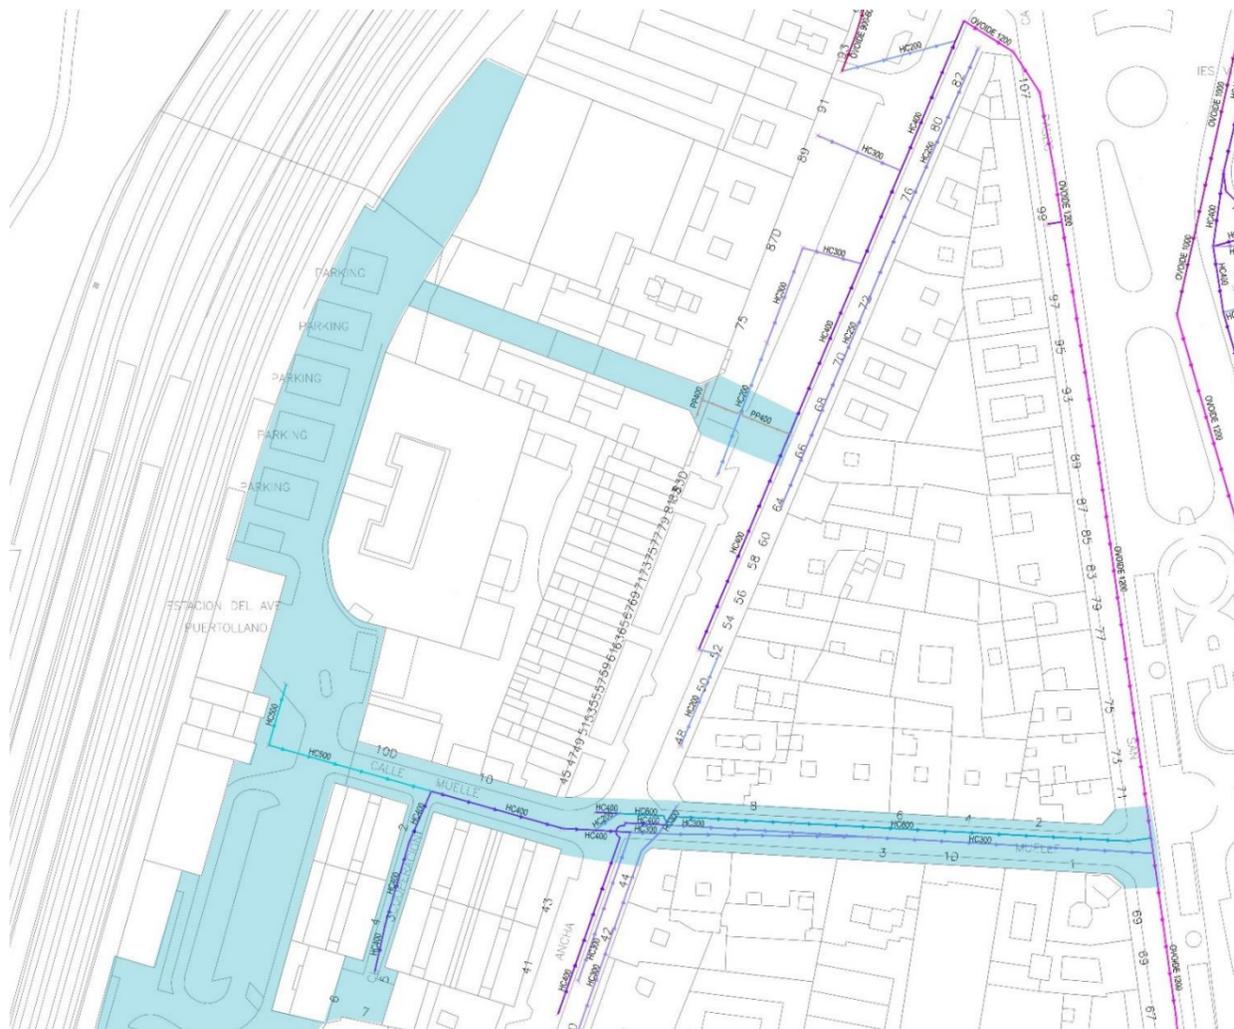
Red de Saneamiento de Puertollano, plano de Abril del 2016. Fuente: Aguas de Puertollano.
